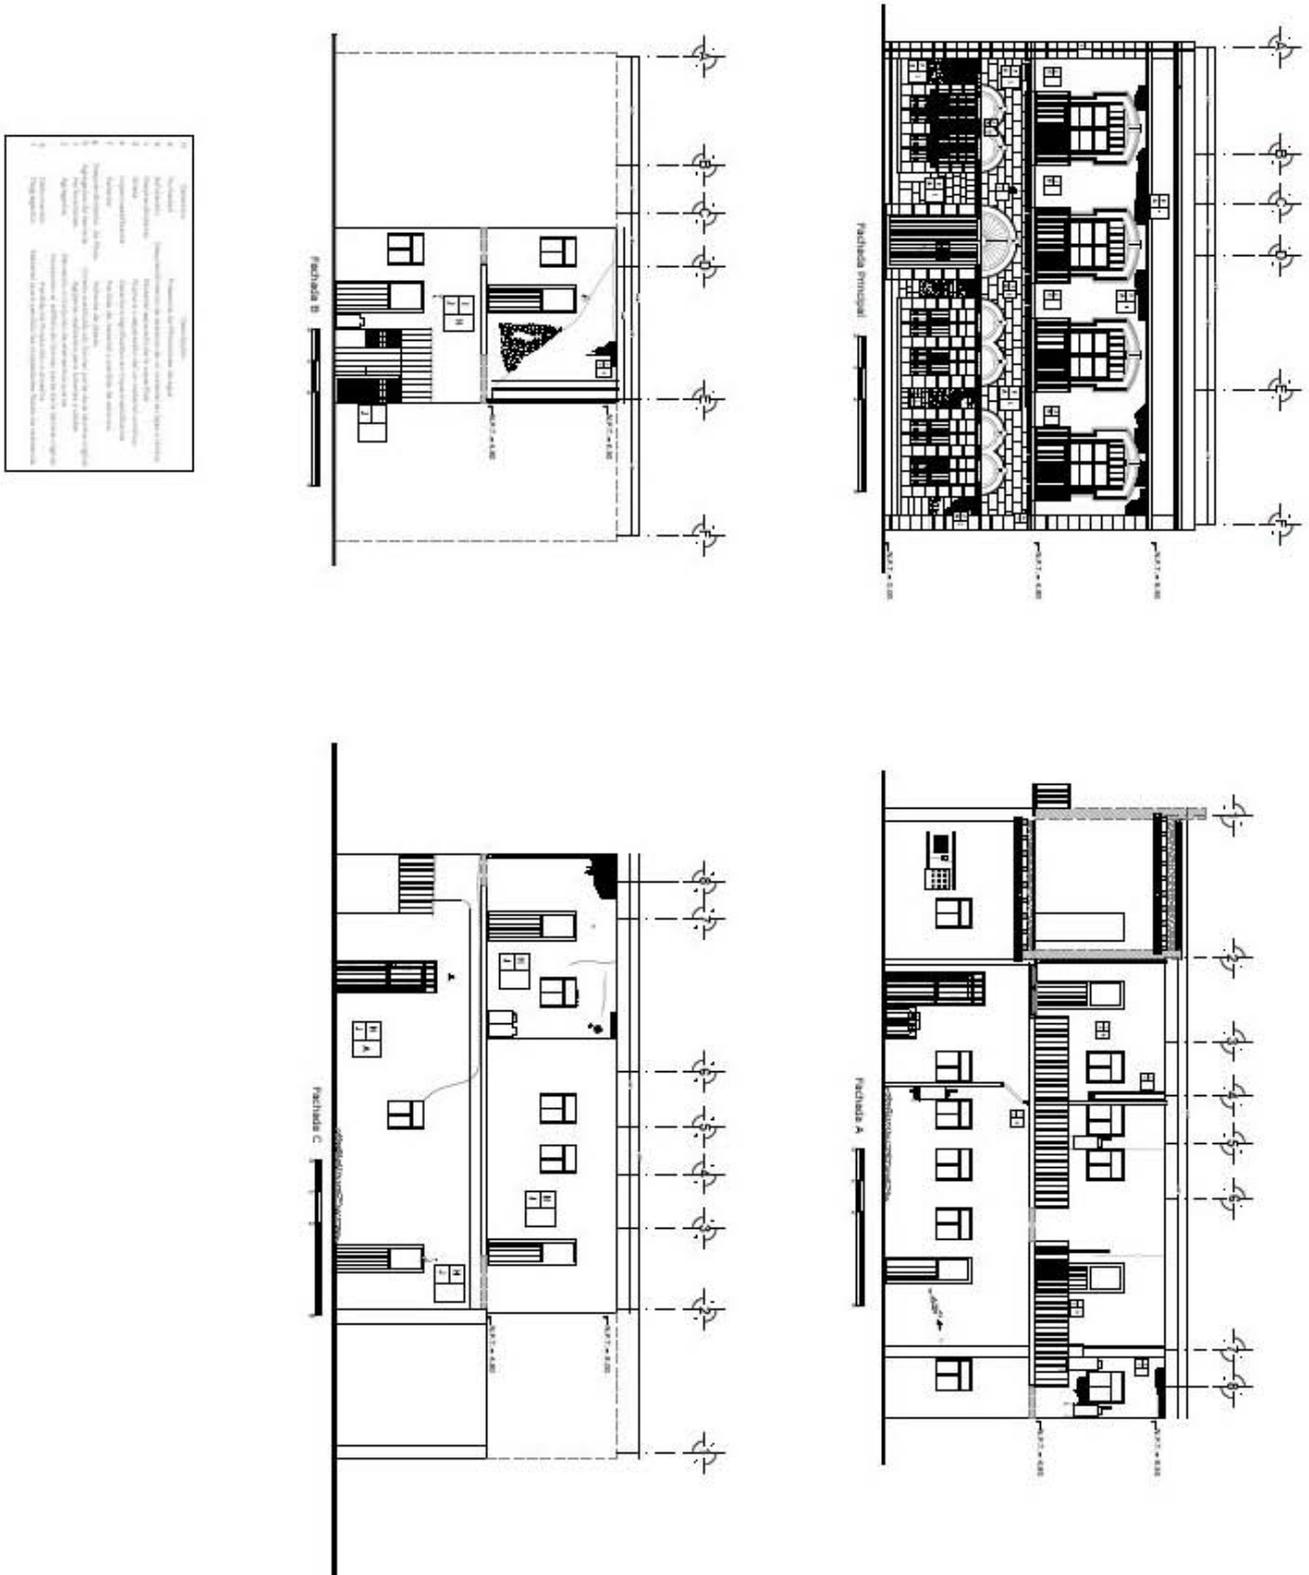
Planos de deterioros en muros de planta baja y planta alta.
